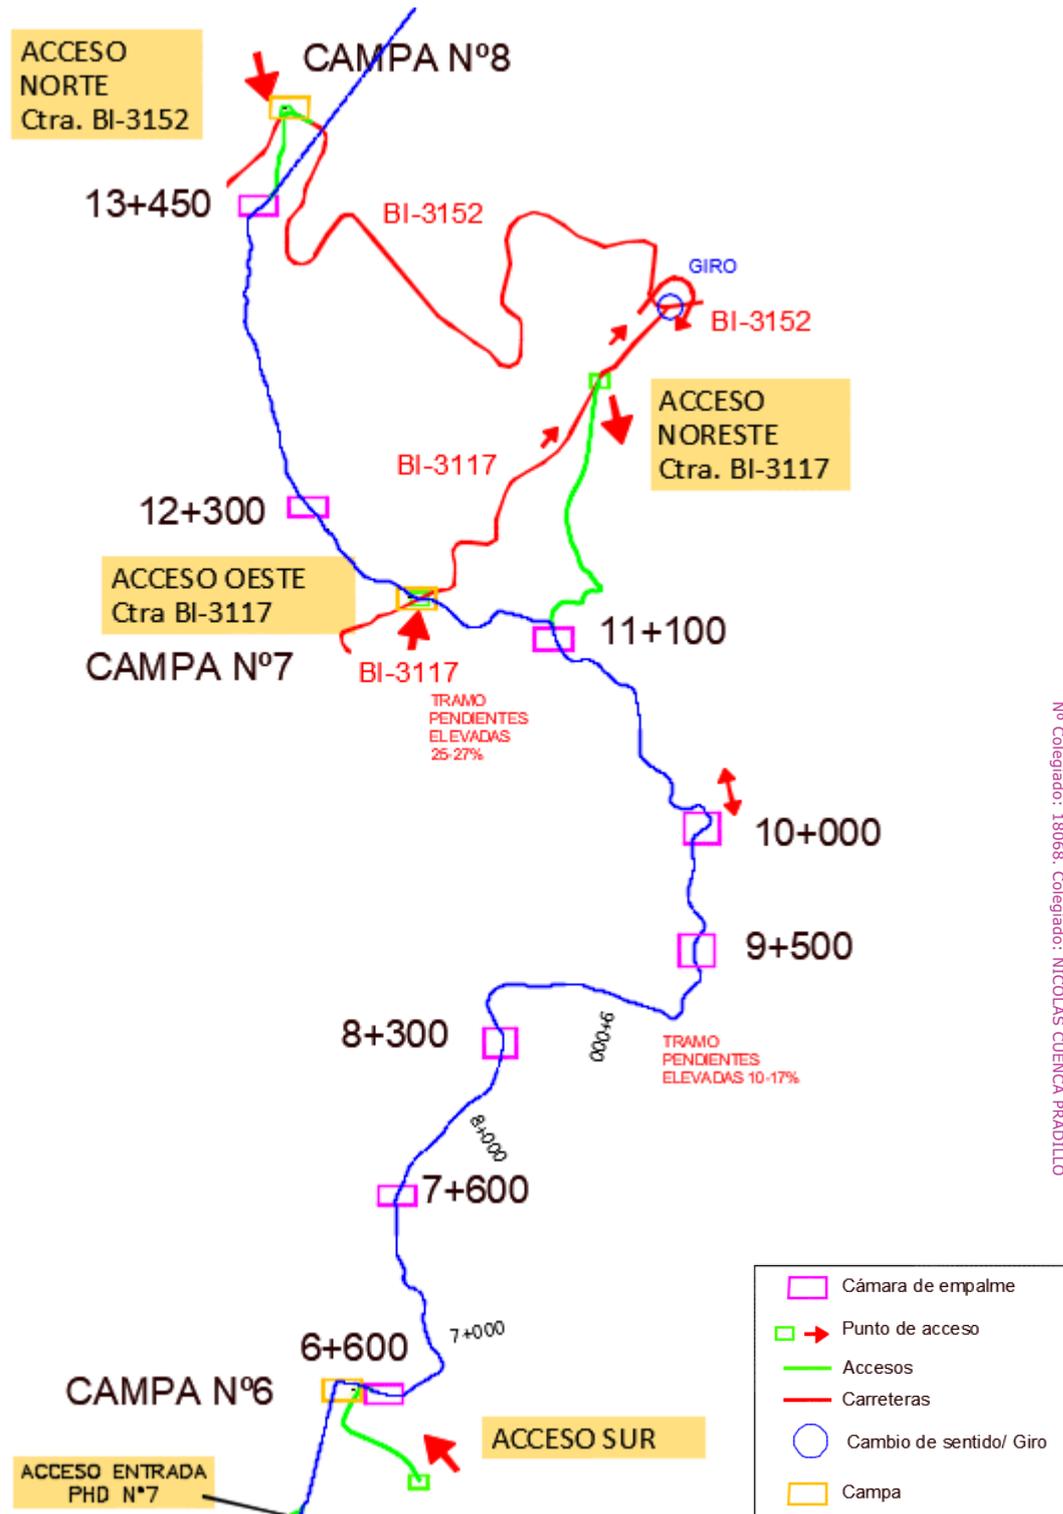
Detalle del esquema de situación de accesos y campas Tramo 6+500-13+515
